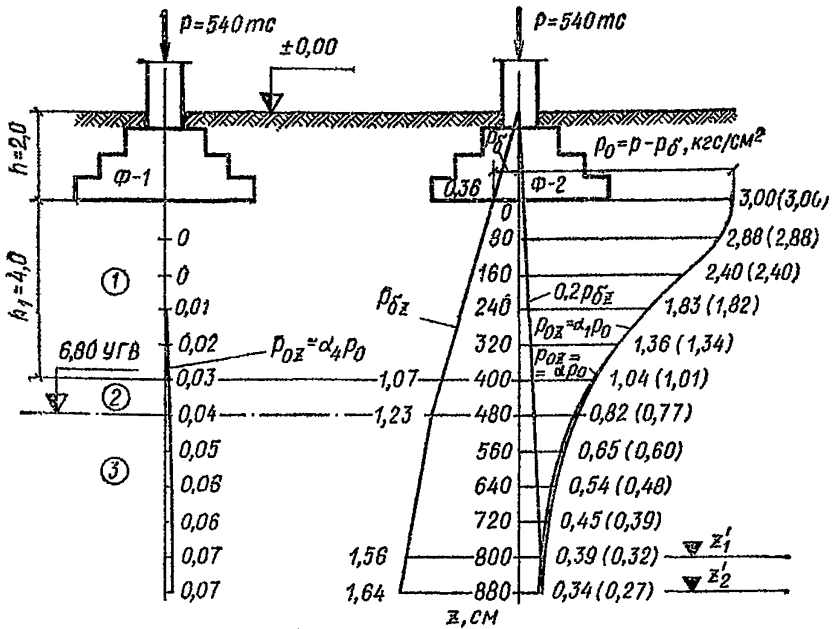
Схемы для примера расчета осадки фундамента Ф-2 с учетом влияния соседнего фундамента Ф-1
